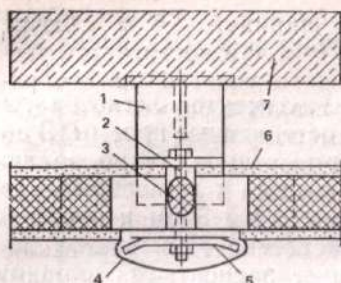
Схема крепления стеновых легкосбрасываемых конструкций
